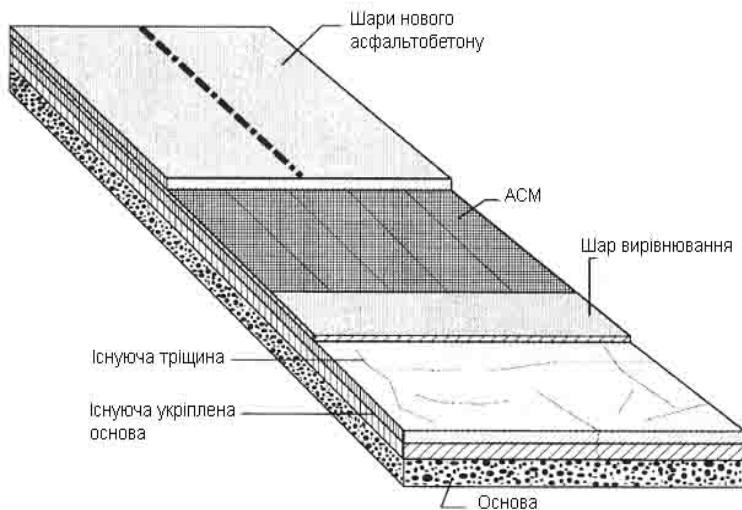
Типова схема армування існуючого дорожнього покриття
